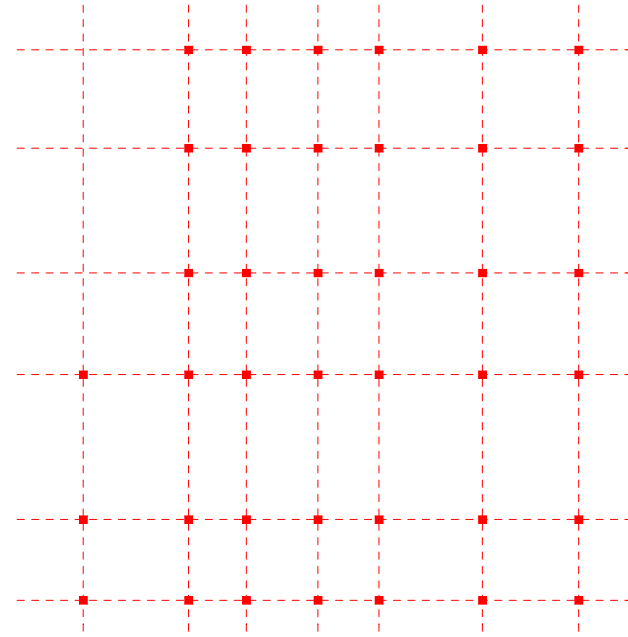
Esquema estructural de las Viviendas Sociales Haussman
